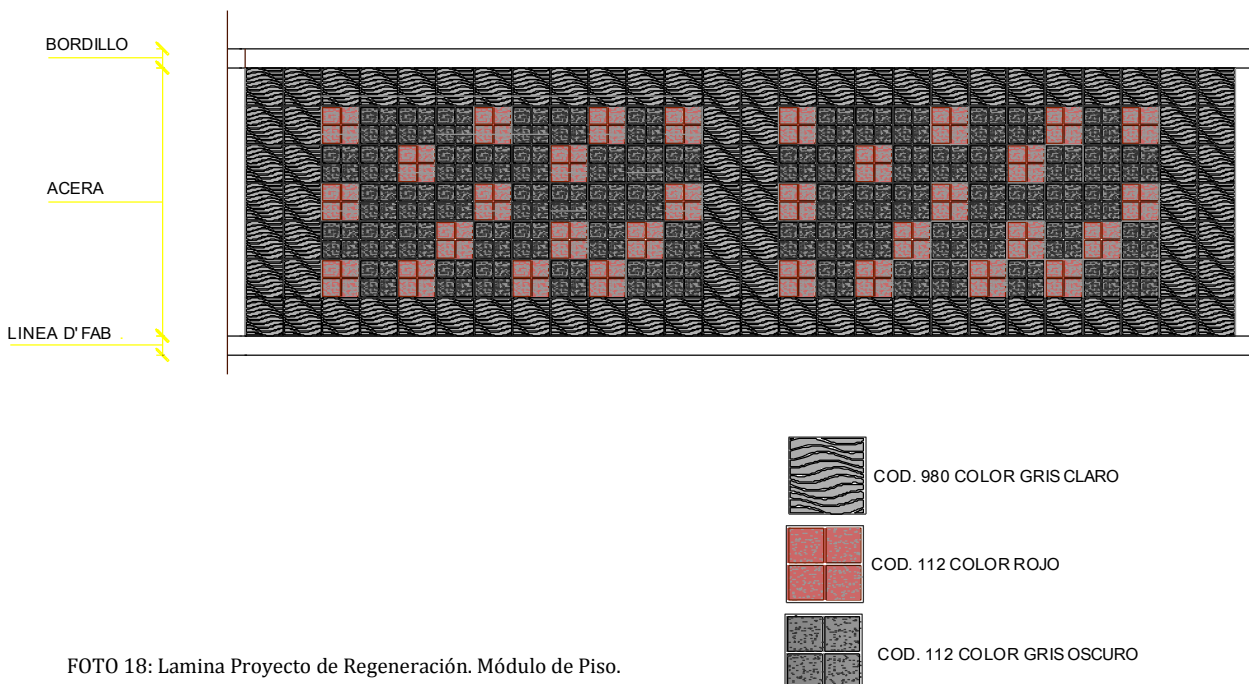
Lamina Proyecto de Regeneración. Módulo de Piso.
